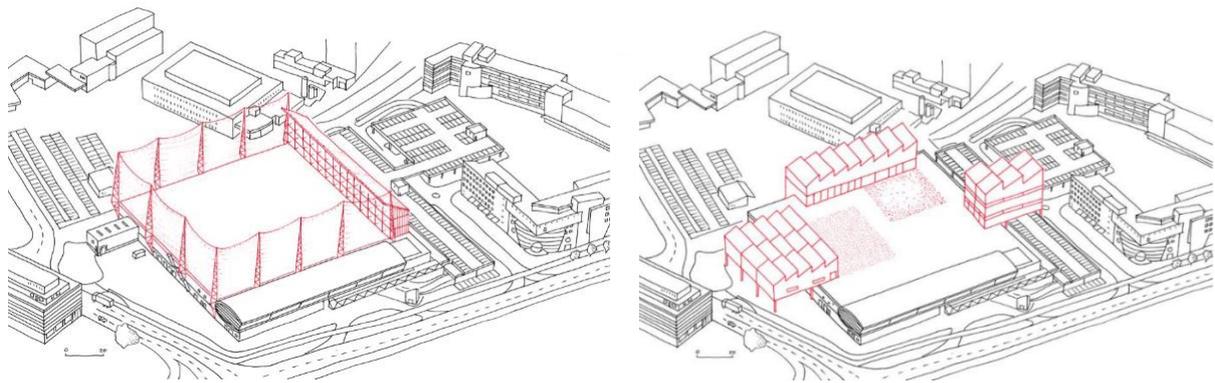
Titelbild Abschlussbericht Urban Sandwich, Landeshauptstadt Stuttgart, 2021.
